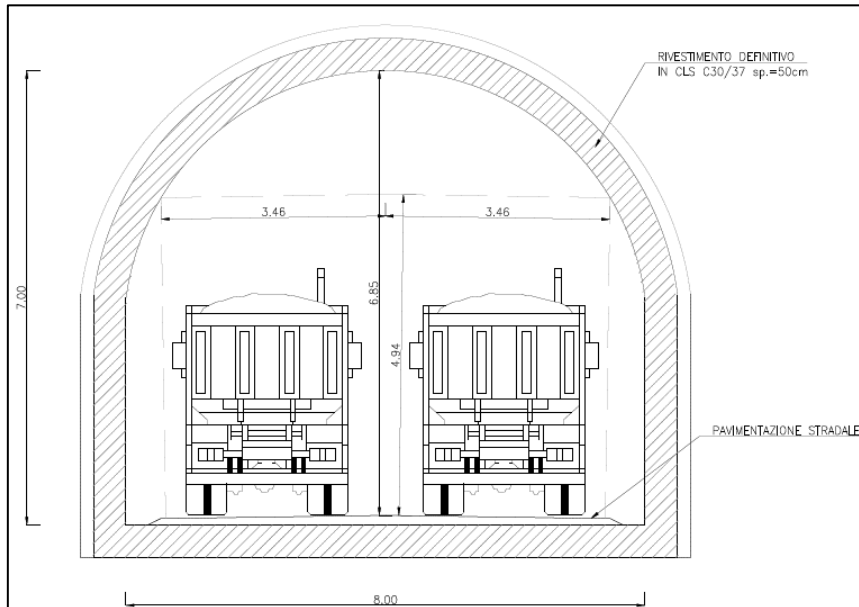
Sezione tipo della galleria d'accesso alla camera alla base del pozzo piezometrico
